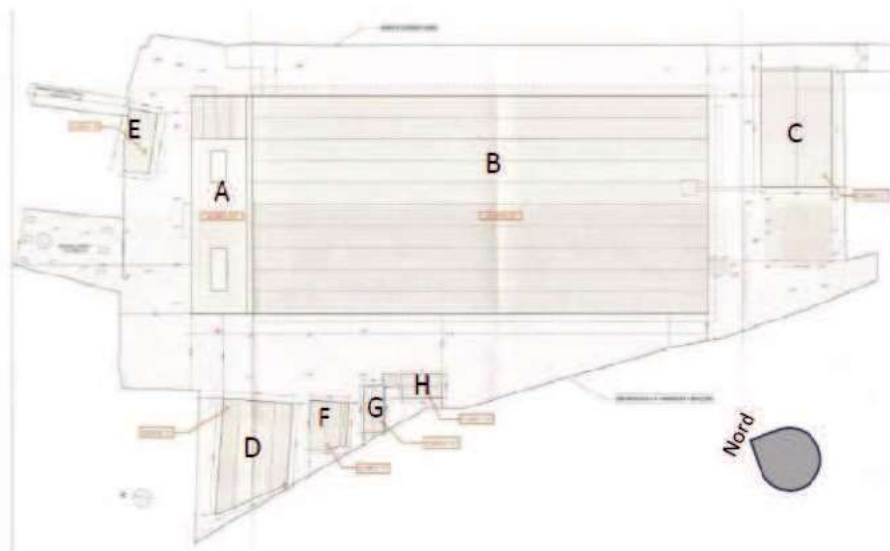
planimetria con ubicazione dei fabbricati esistenti
